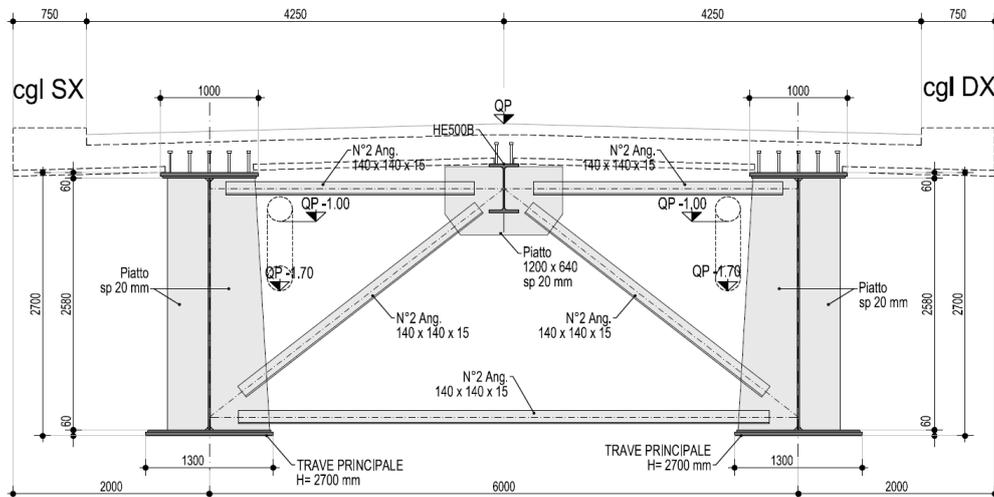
SEZIONE TRASVERSALE IMPALCATO IN CAMPATA 2
